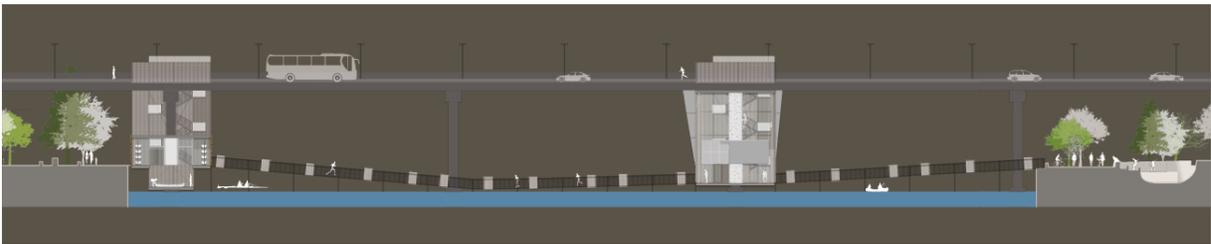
Section de coupe longitudinale - expression de la passerelle
